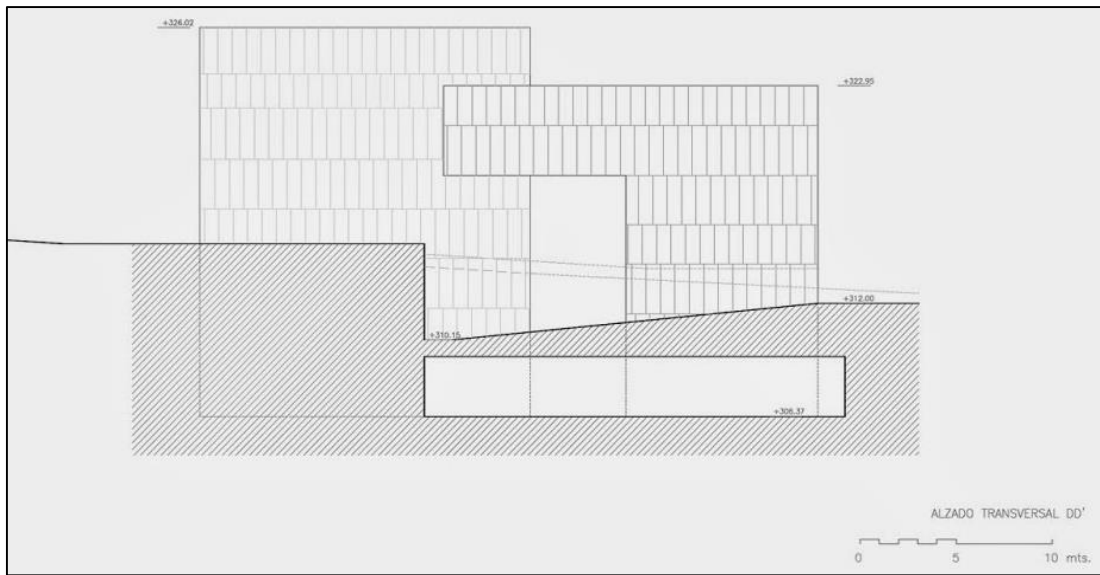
Alzado Transversal del Centro de Artes Escénicas de Níjar.
